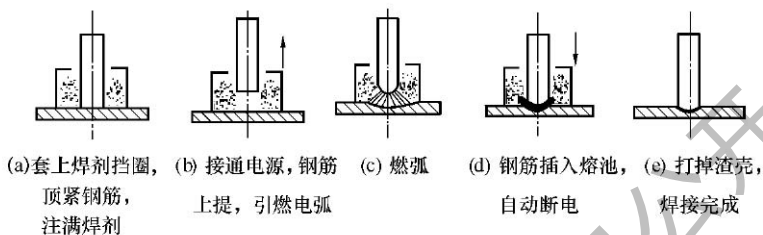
预埋件钢筋埋弧螺柱焊示意
